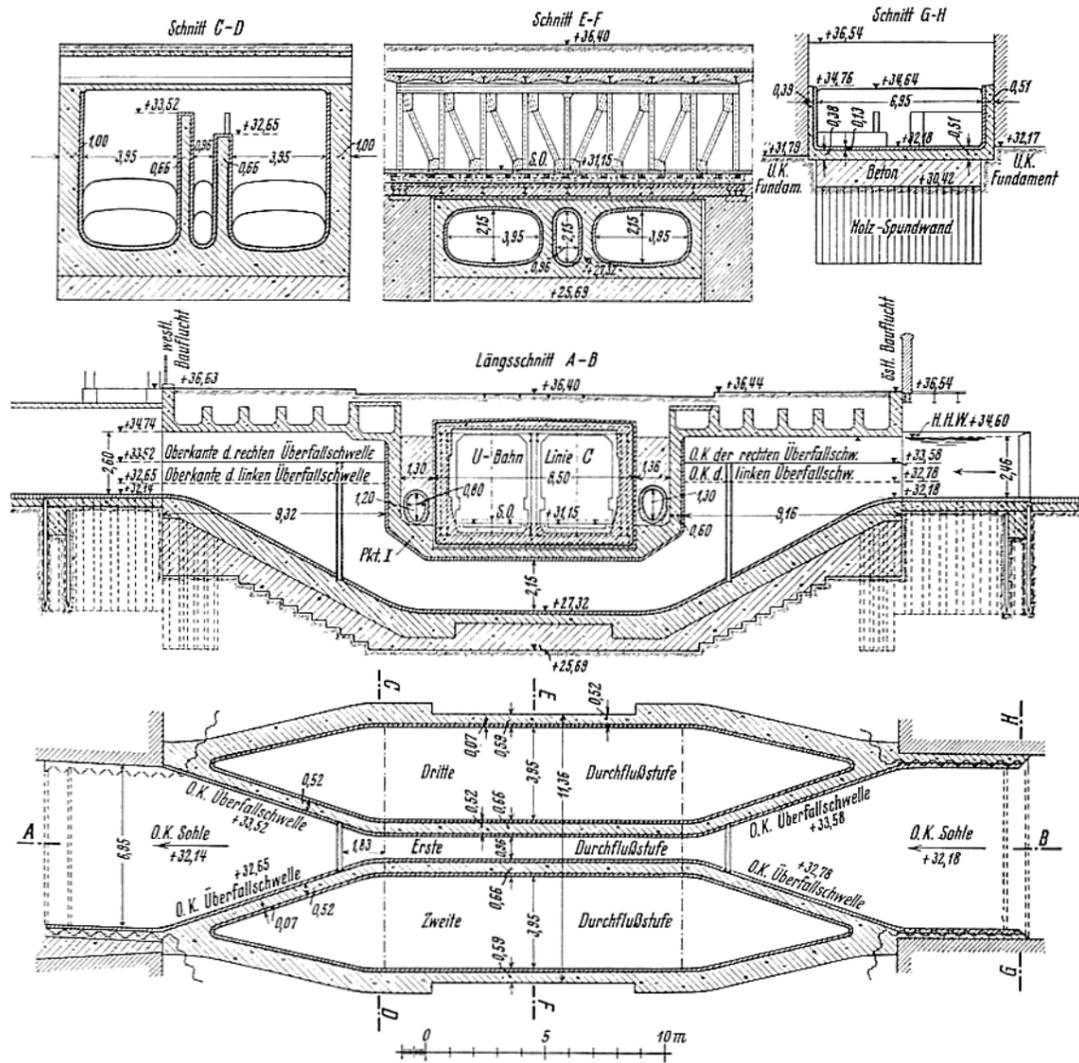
Flußdücker (Schönhauser Graben) am nördlichen Ende der Chausseestraße (Linie C).
